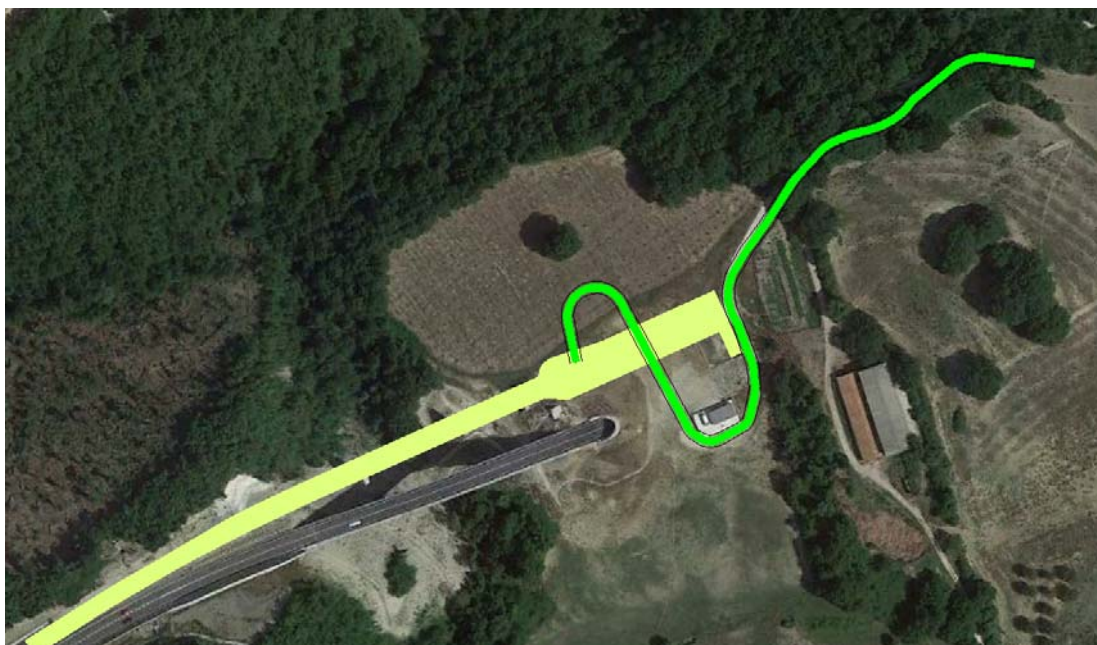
Stralcio ortofoto cantiere operativo Tre Vescovi.
